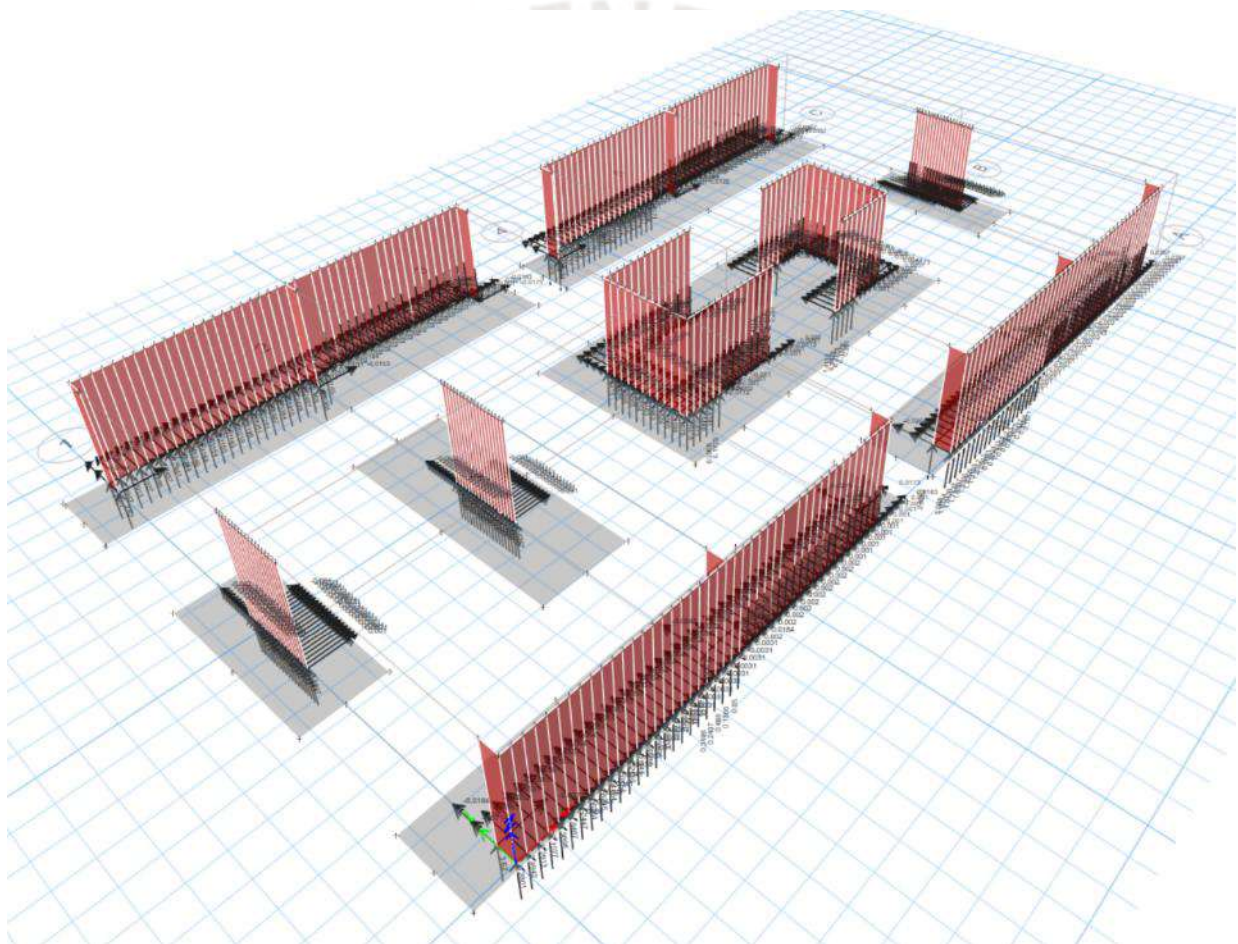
Dimensiones en planta de zapatas por cargas de servicio
